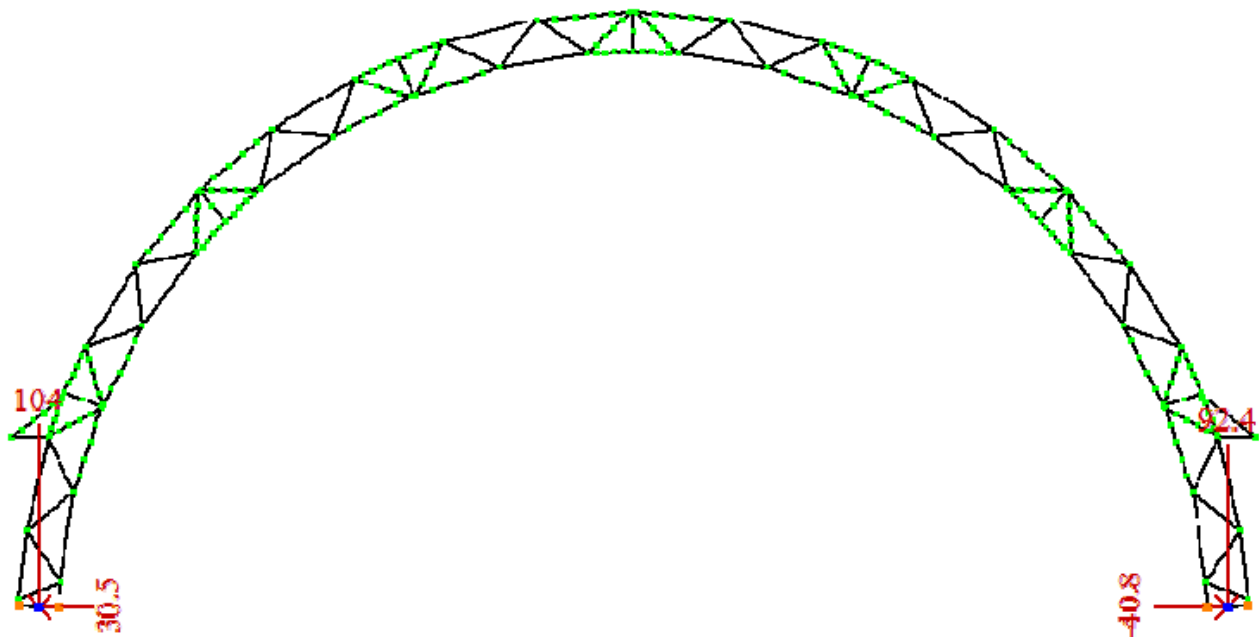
Схема навантаження на фундаменти від зв'язкових арок та розрахункової комбінації зусиль.
